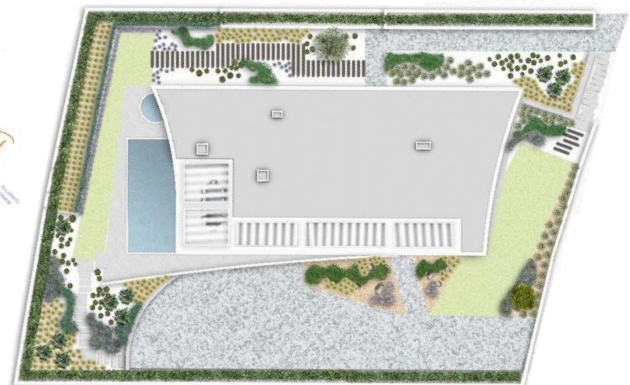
Primeira fase de desenho do Plano Geral do Lote 4 da Urbanização Monte Lemos, Lagos, realizado pela autora. Fonte: Jardim Vista, 2022. Edição: Autora.
